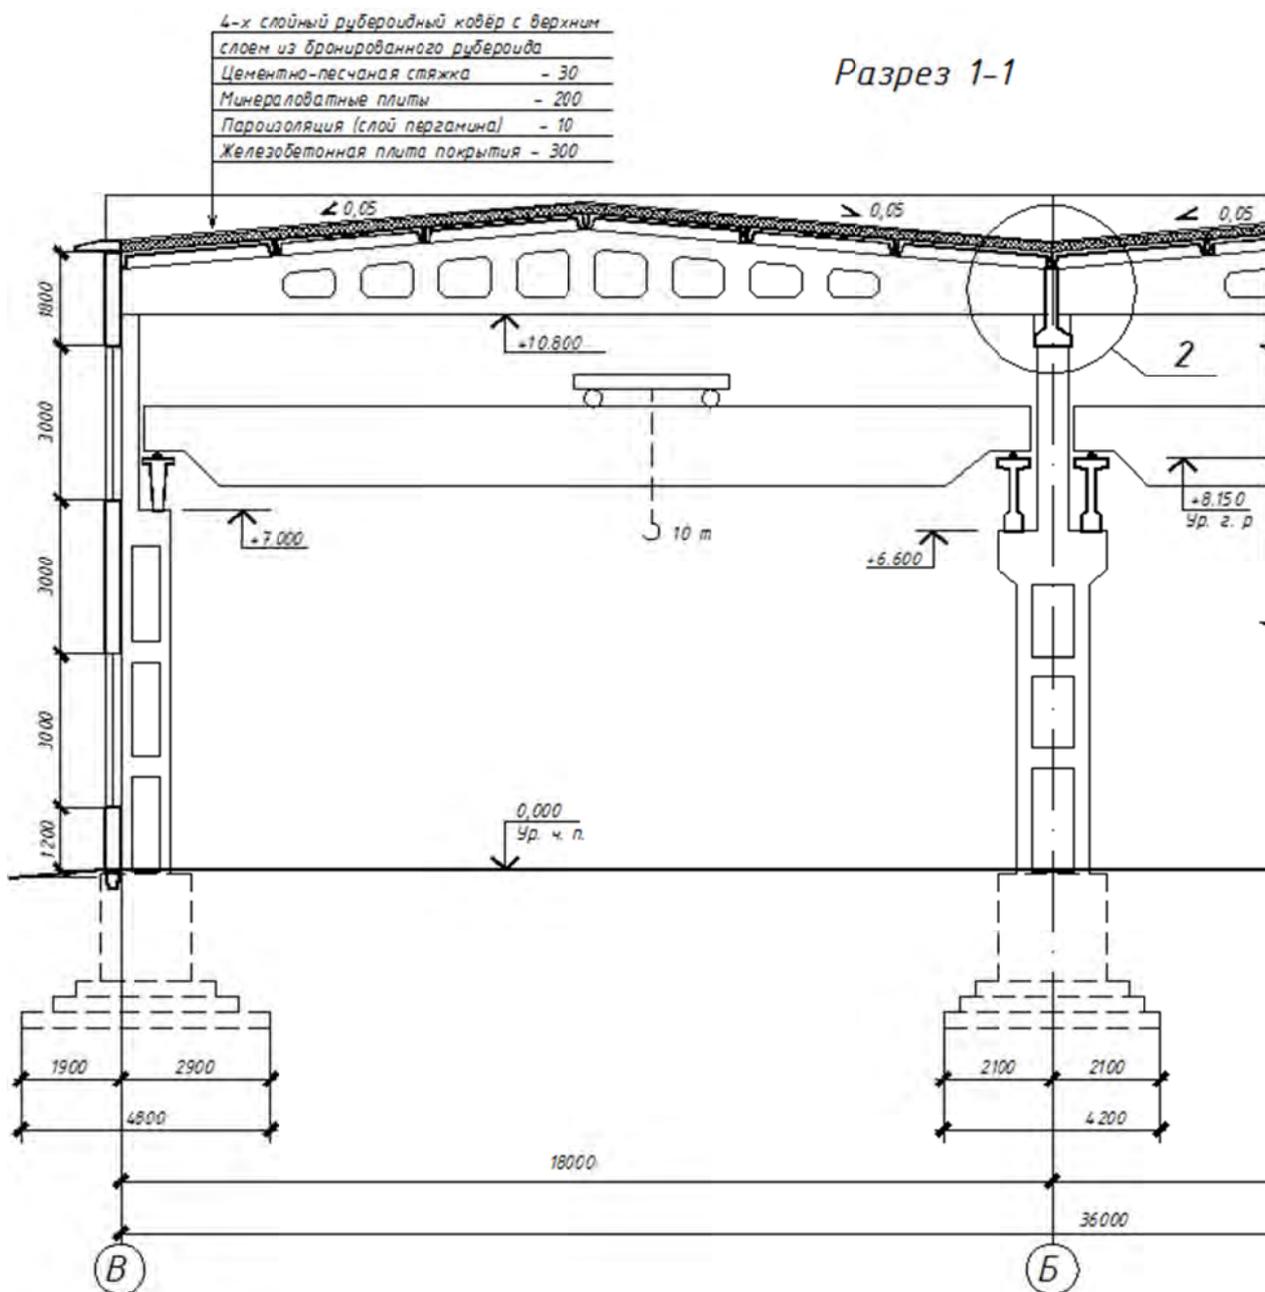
Фрагмент разреза (поперечный) промышленного здания каркасного типа
